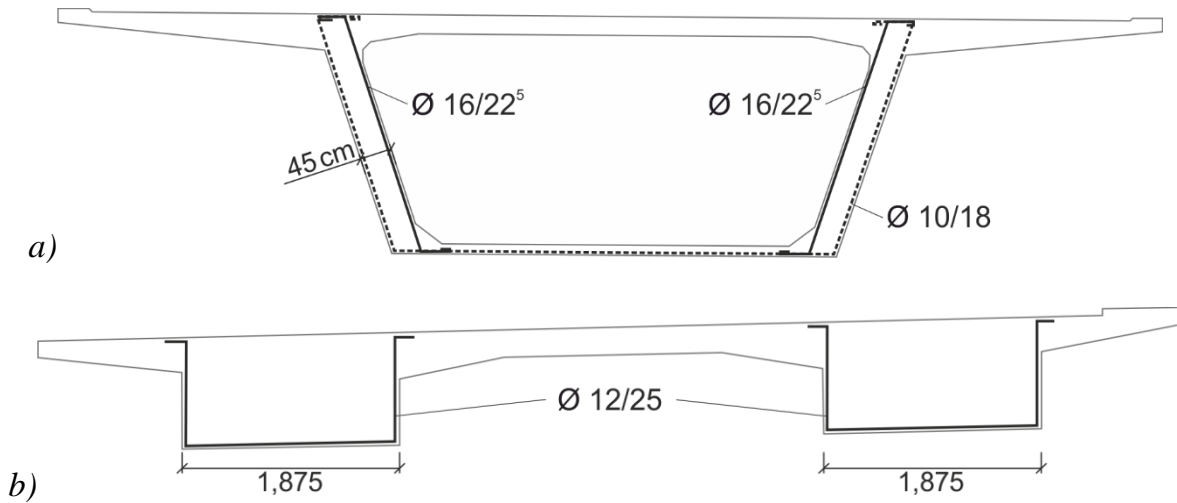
Querkraftbewehrung im Querschnitt: a) Brücke B; b) Brücke C
